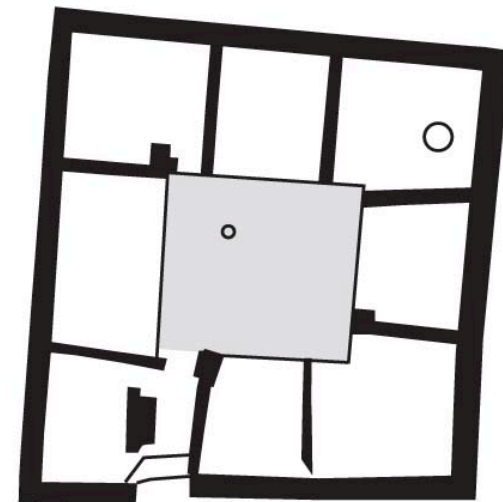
BĀMIYĀN. PLAN D'UNE M
